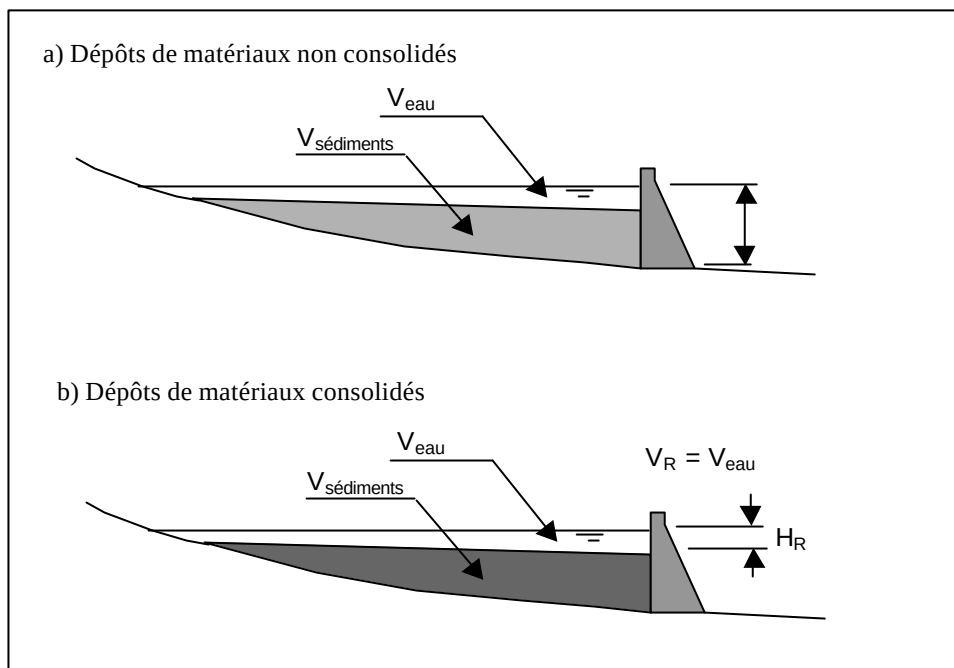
Définition de la hauteur de retenue H_R et du volume accumulé V_R pour un ouvrage d'accumulation avec dépôts de matériaux solides
